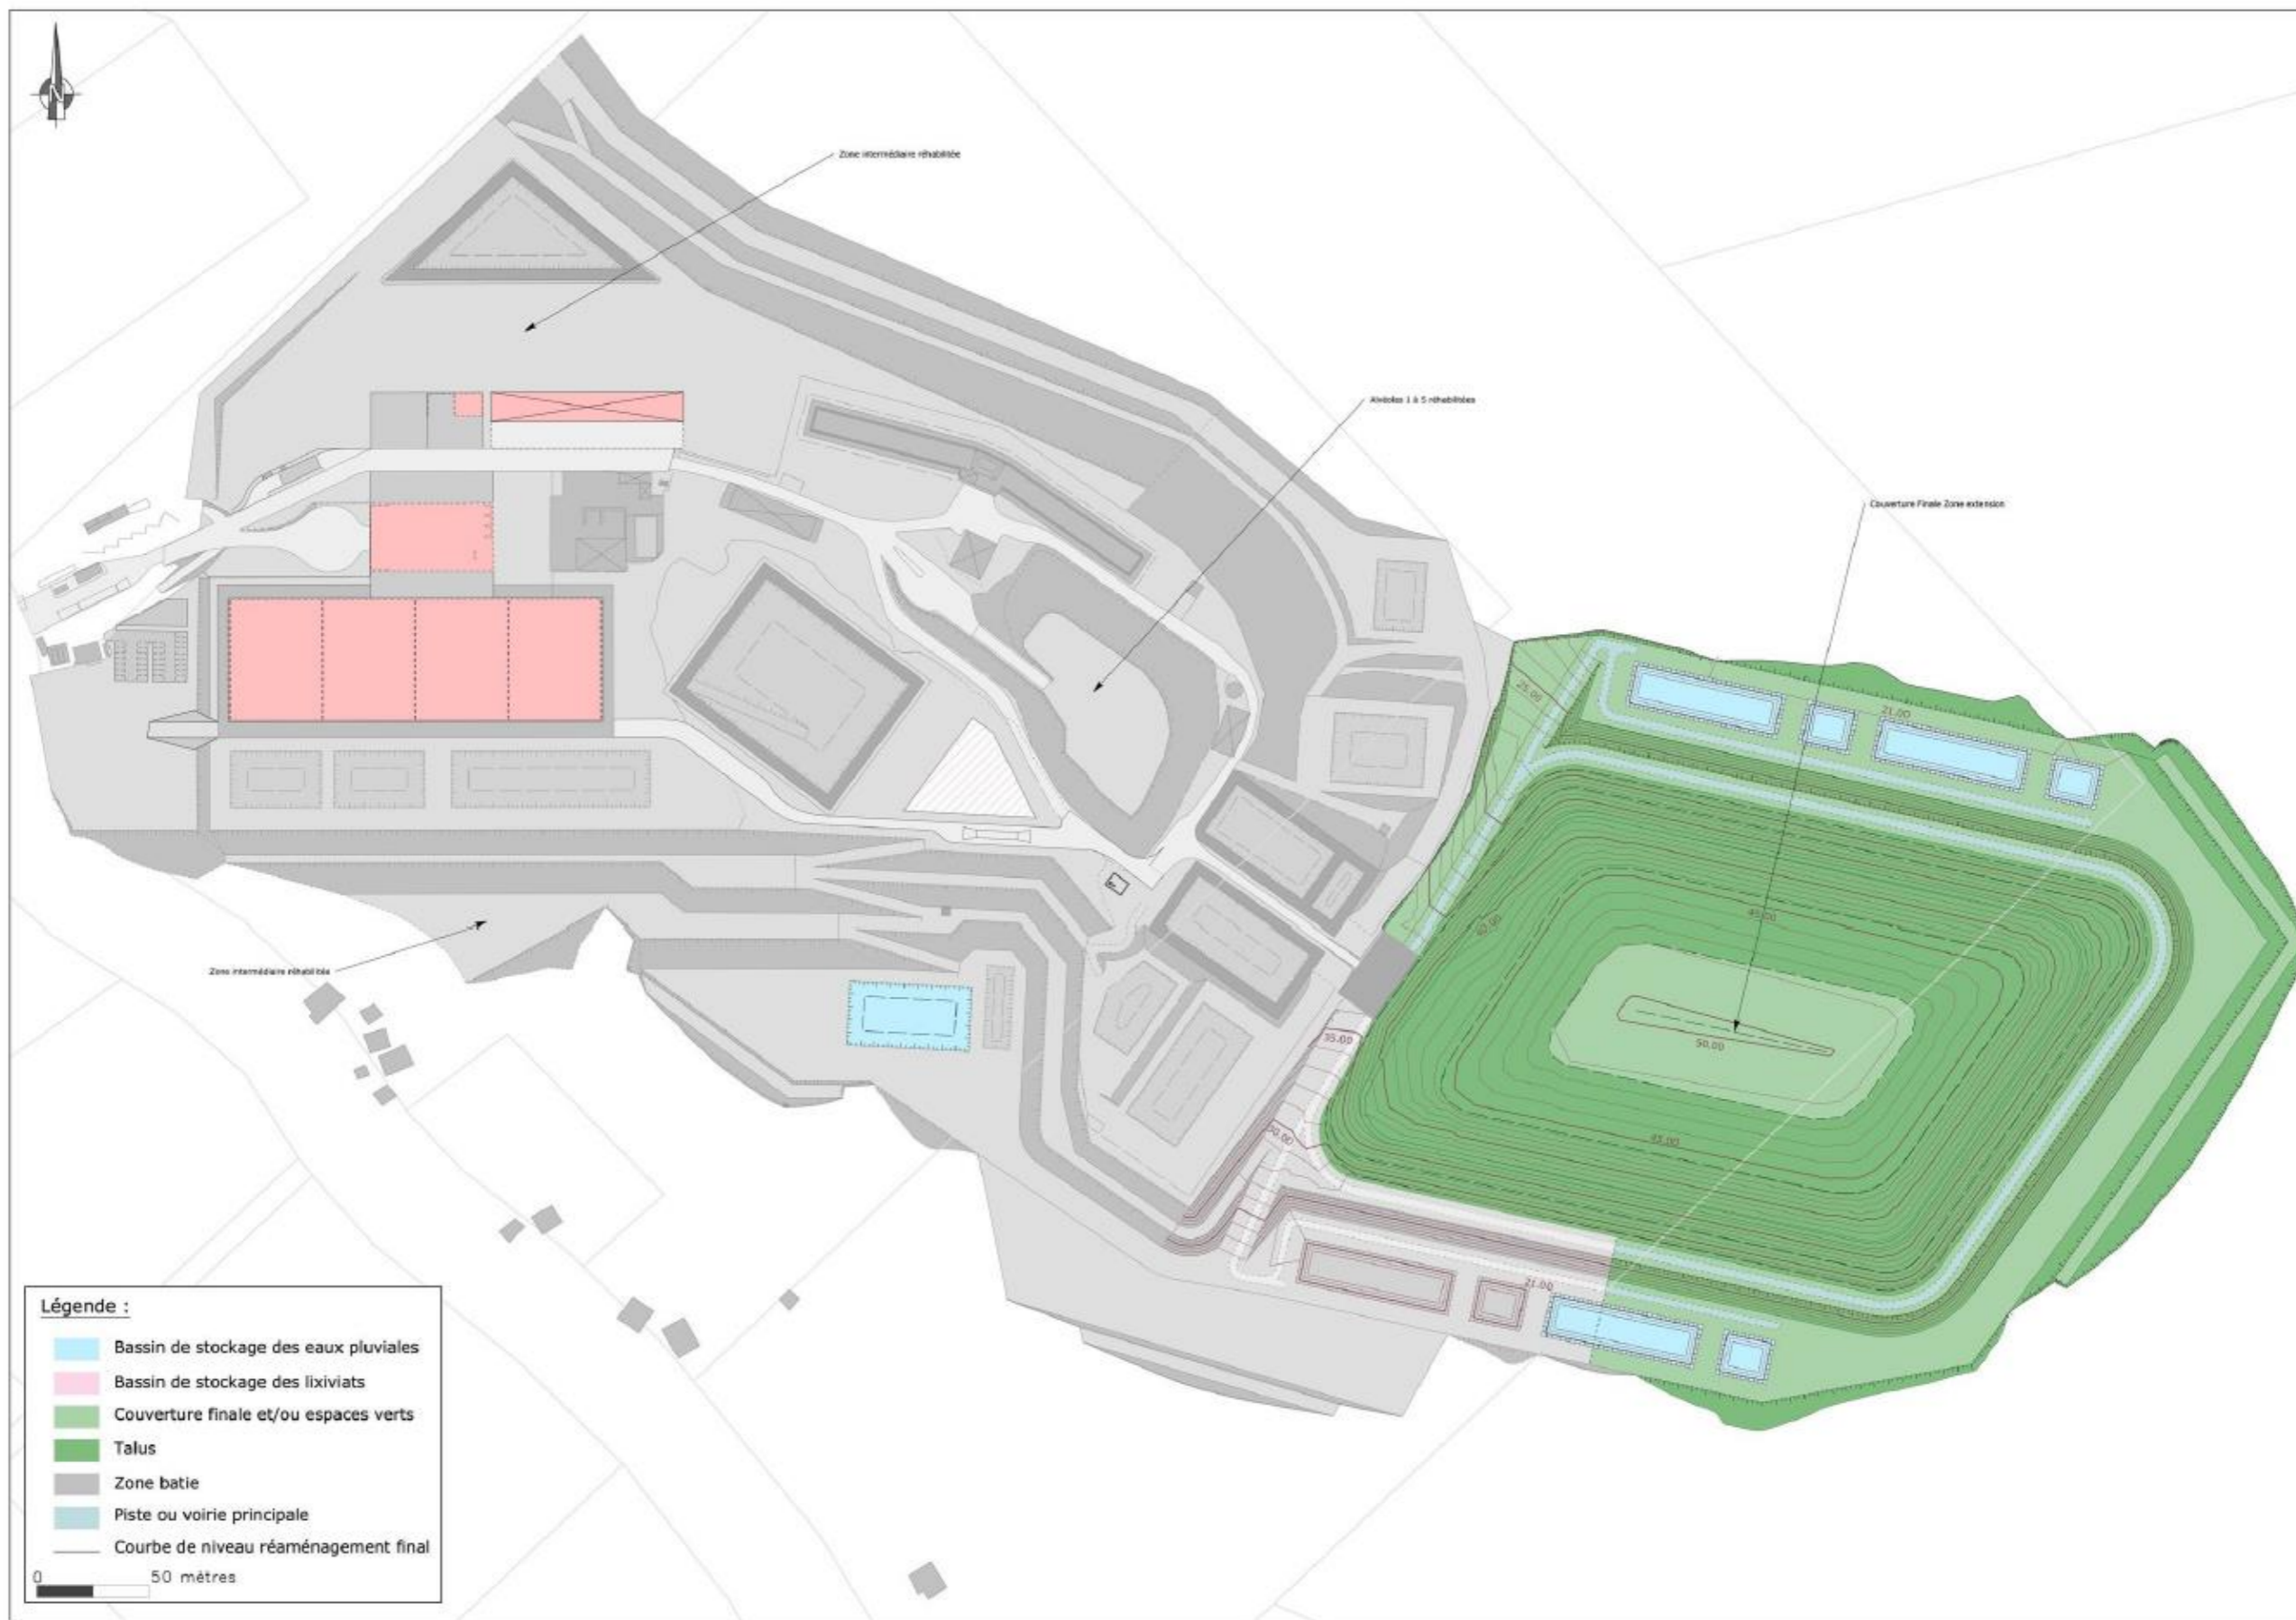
Plan de réaménagement final (Source : BETA Environnement)
